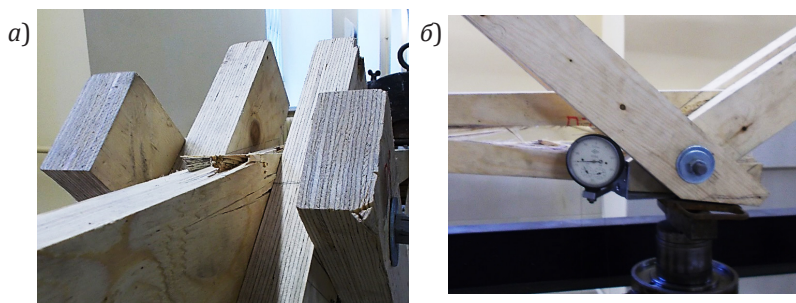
Узлы разрушенной конструкции фермы: а – нижний пояс (место установки П8); б – верхний пояс (место установки П7)
